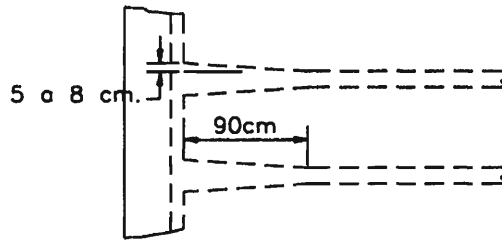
Ensanchamiento de las viguetas de losas nervadas en los apoyos
